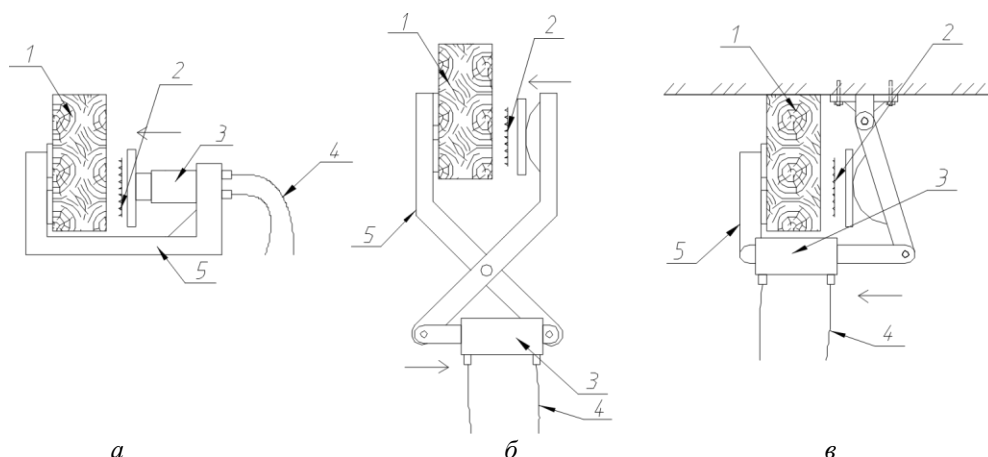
Способы запрессовки МЗП для усиления балки: *а* – по типу «скоба»; *б* – по типу «ножницы»; *в* – с опорой на плиту перекрытия; 1 – деревянная балка; 2 – МЗП; 3 – гидравлический цилиндр; 4 – гидропривод; 5 – опорное устройство
